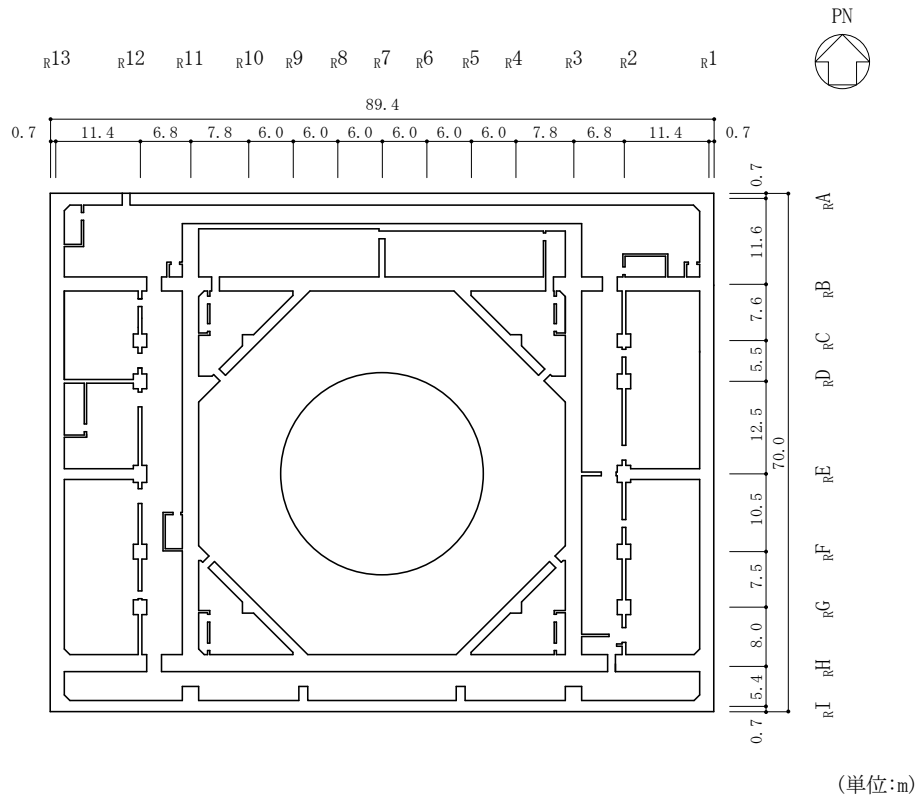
(1) 原子炉建物の概略平面図 (EL 1.3m\*)
